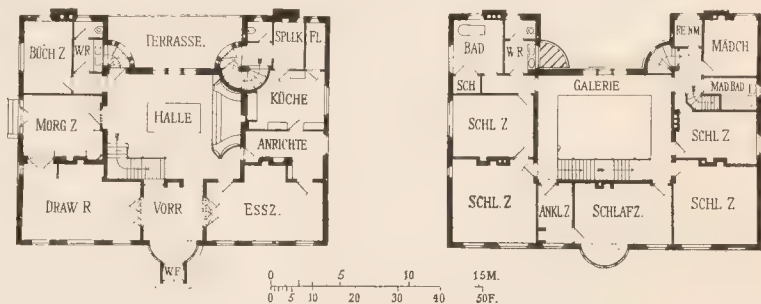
und 178. Haus The Leys in Elstree bei London. Erbaut von George Walton. Erdgeschoß und erstes Stockwerk. 1:400.
